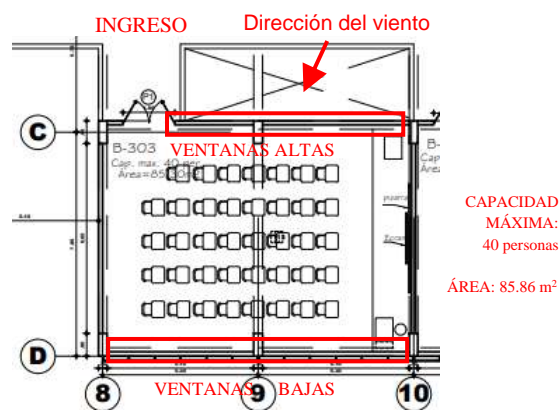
Pabellón B Facultad de Ingeniería Aula B-303
